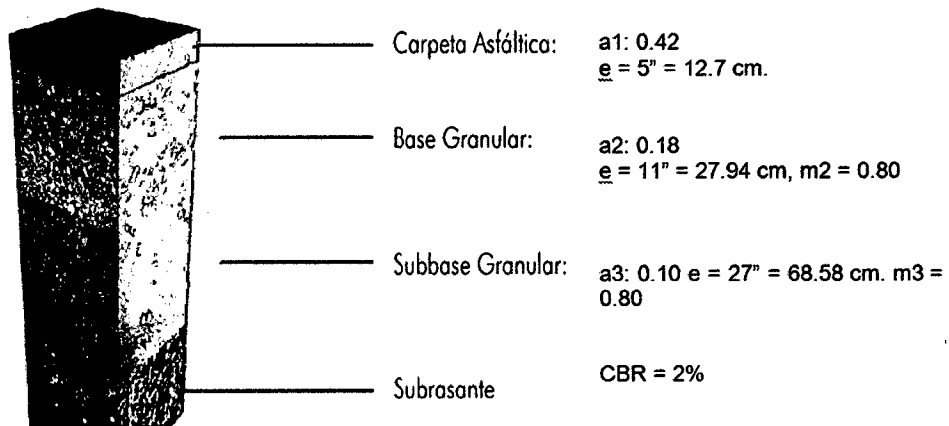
Características del diseño de pavimento Av Salomón Vilchez Murga
